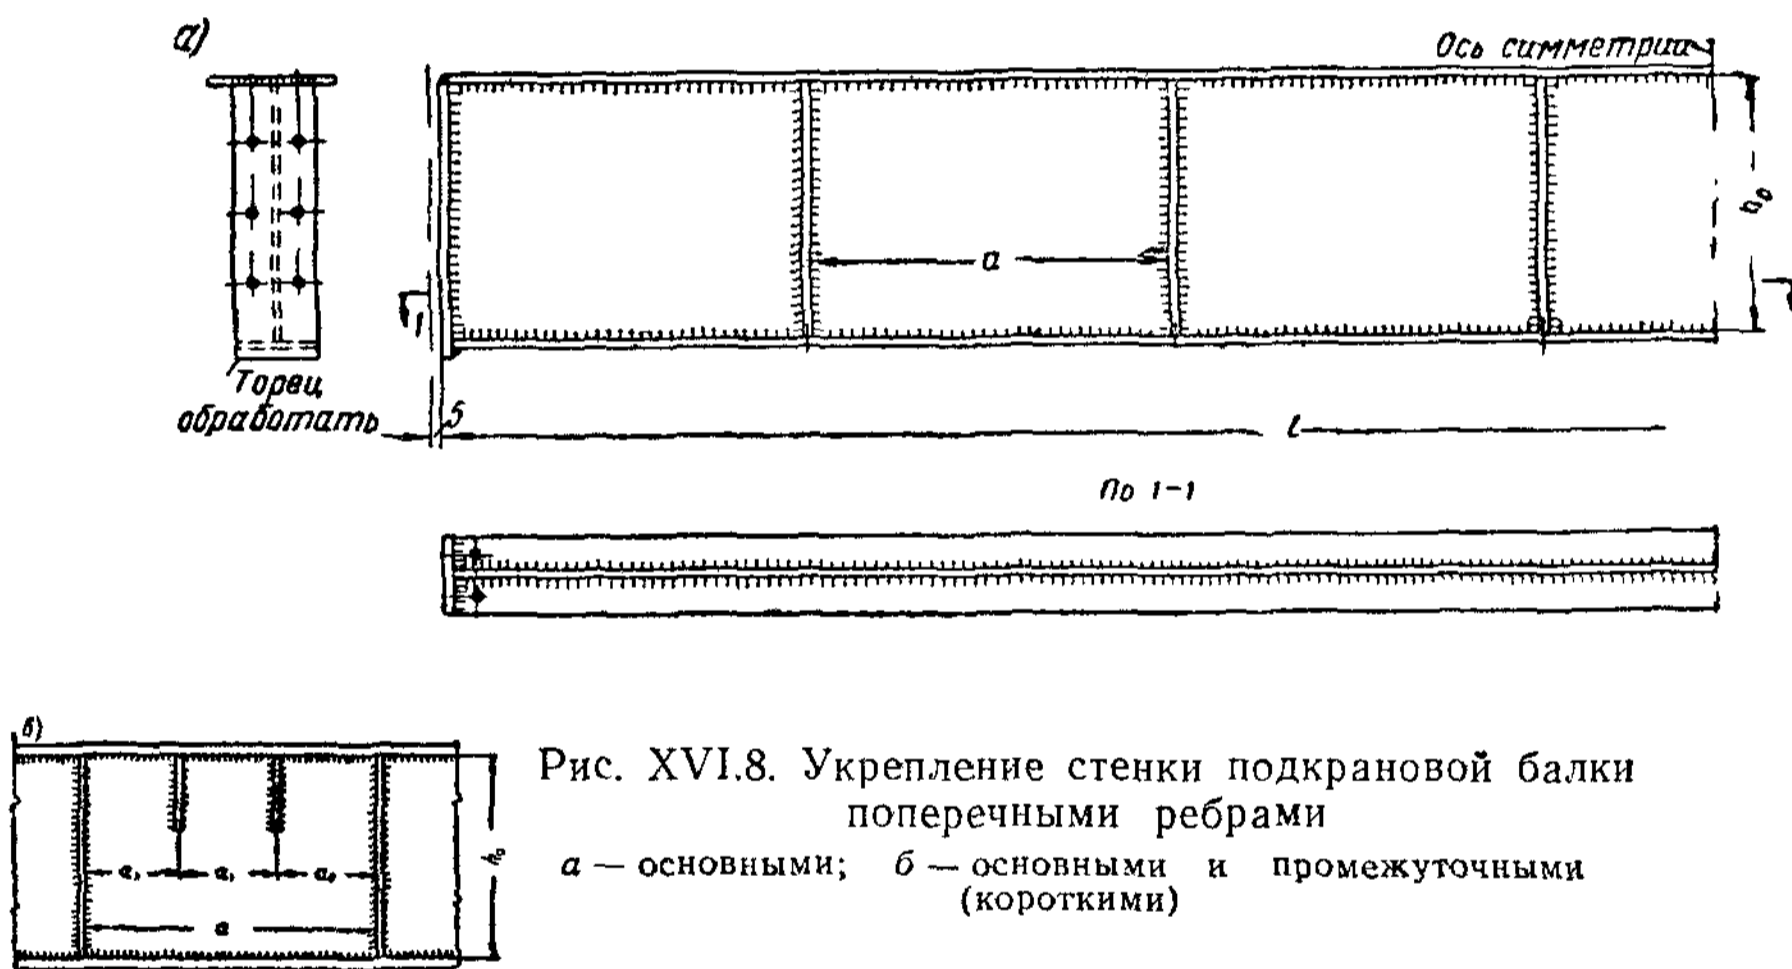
Укрепление стенки подкрановой балки поперечными ребрами
